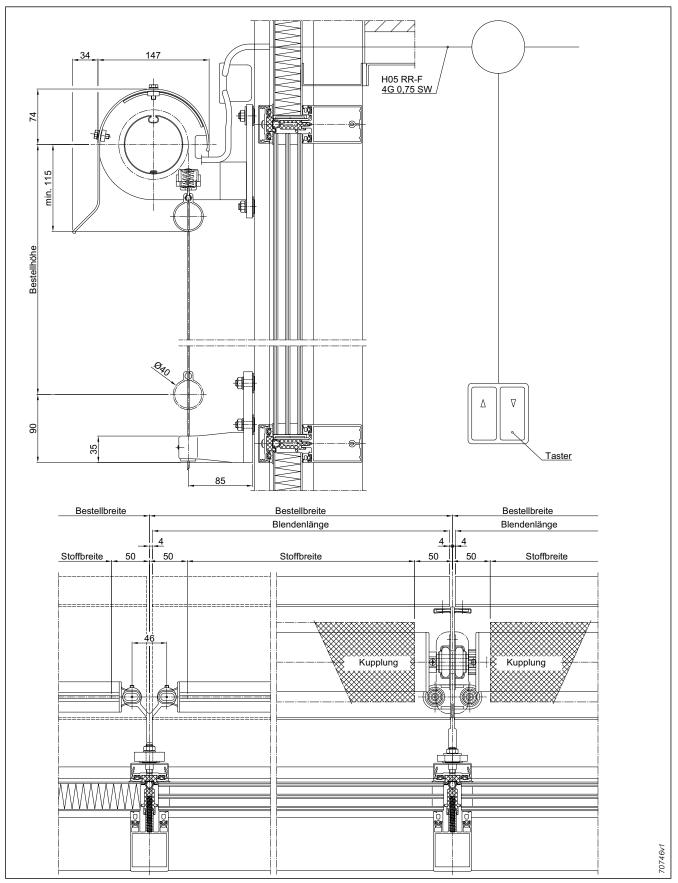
Fassaden-Markise 207 mit Halbrundblende Typ 2.3
